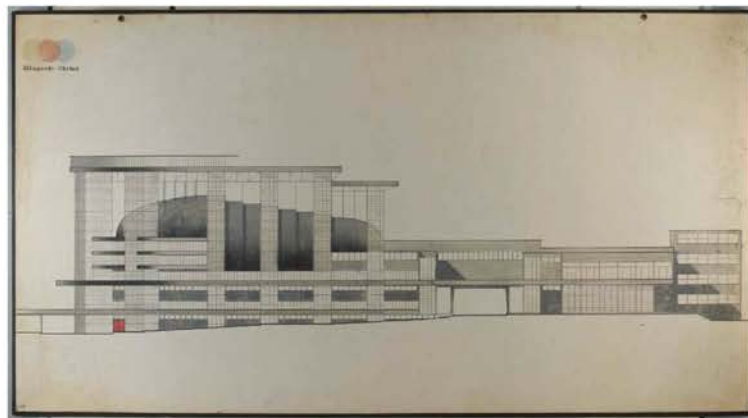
Bauhaus Archive Berlin : Eine Stadtkrone für Halle Saale.
